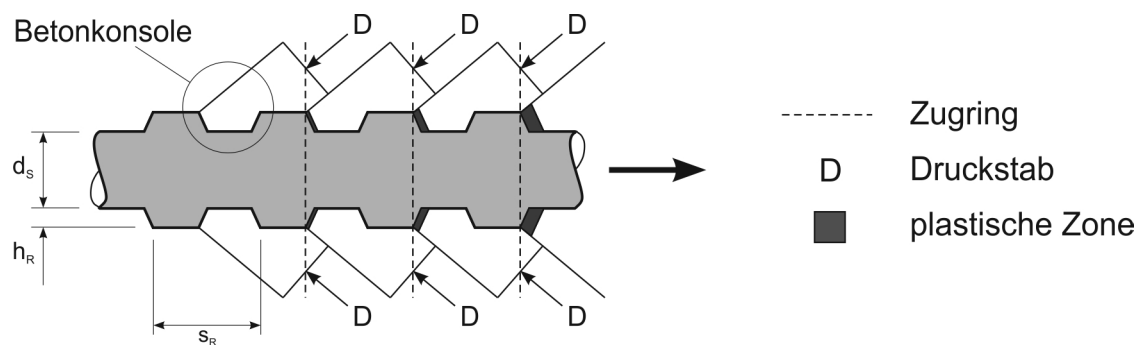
Detaildarstellung der Kraftübertragung zwischen Bewehrung und Beton [9]
